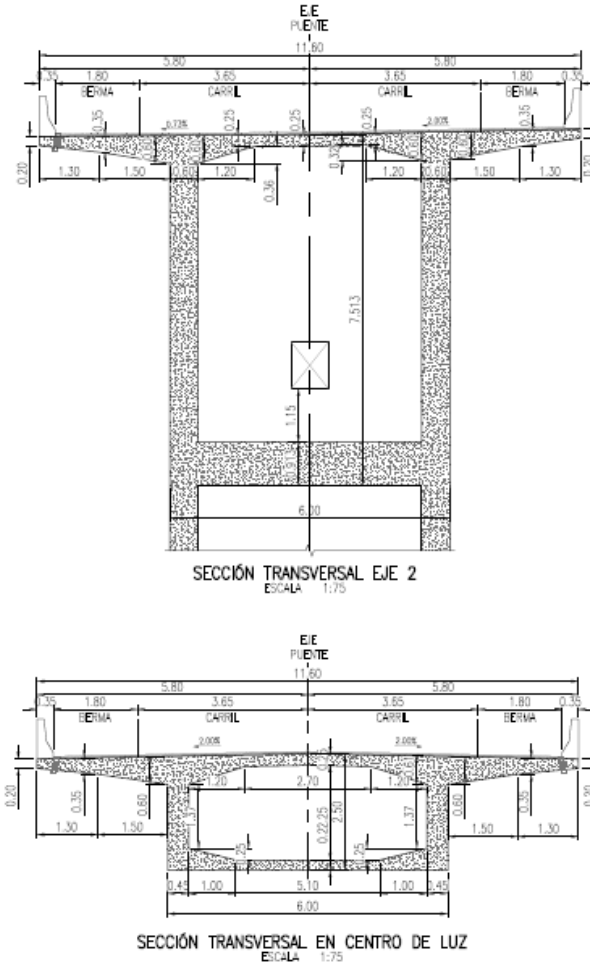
Sección transversal caso estudio 1. Tomado del plano sección general transversal.
